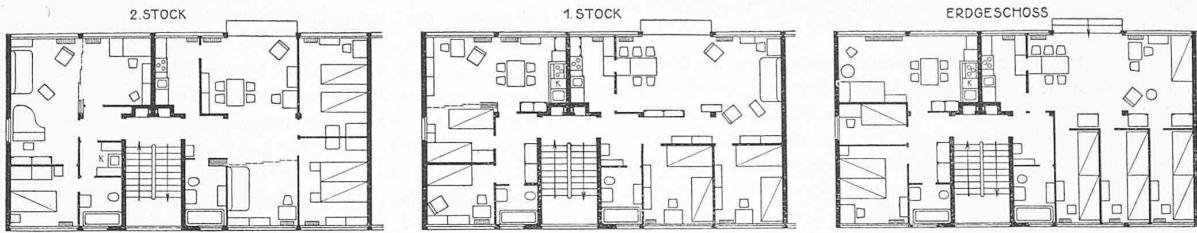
Grundrisse der sechs Wohnungen der Schweizer-Gruppe im Miethausblock M. v. d. Rohe, Stuttgart 1927. — Masstab 1 : 300.
